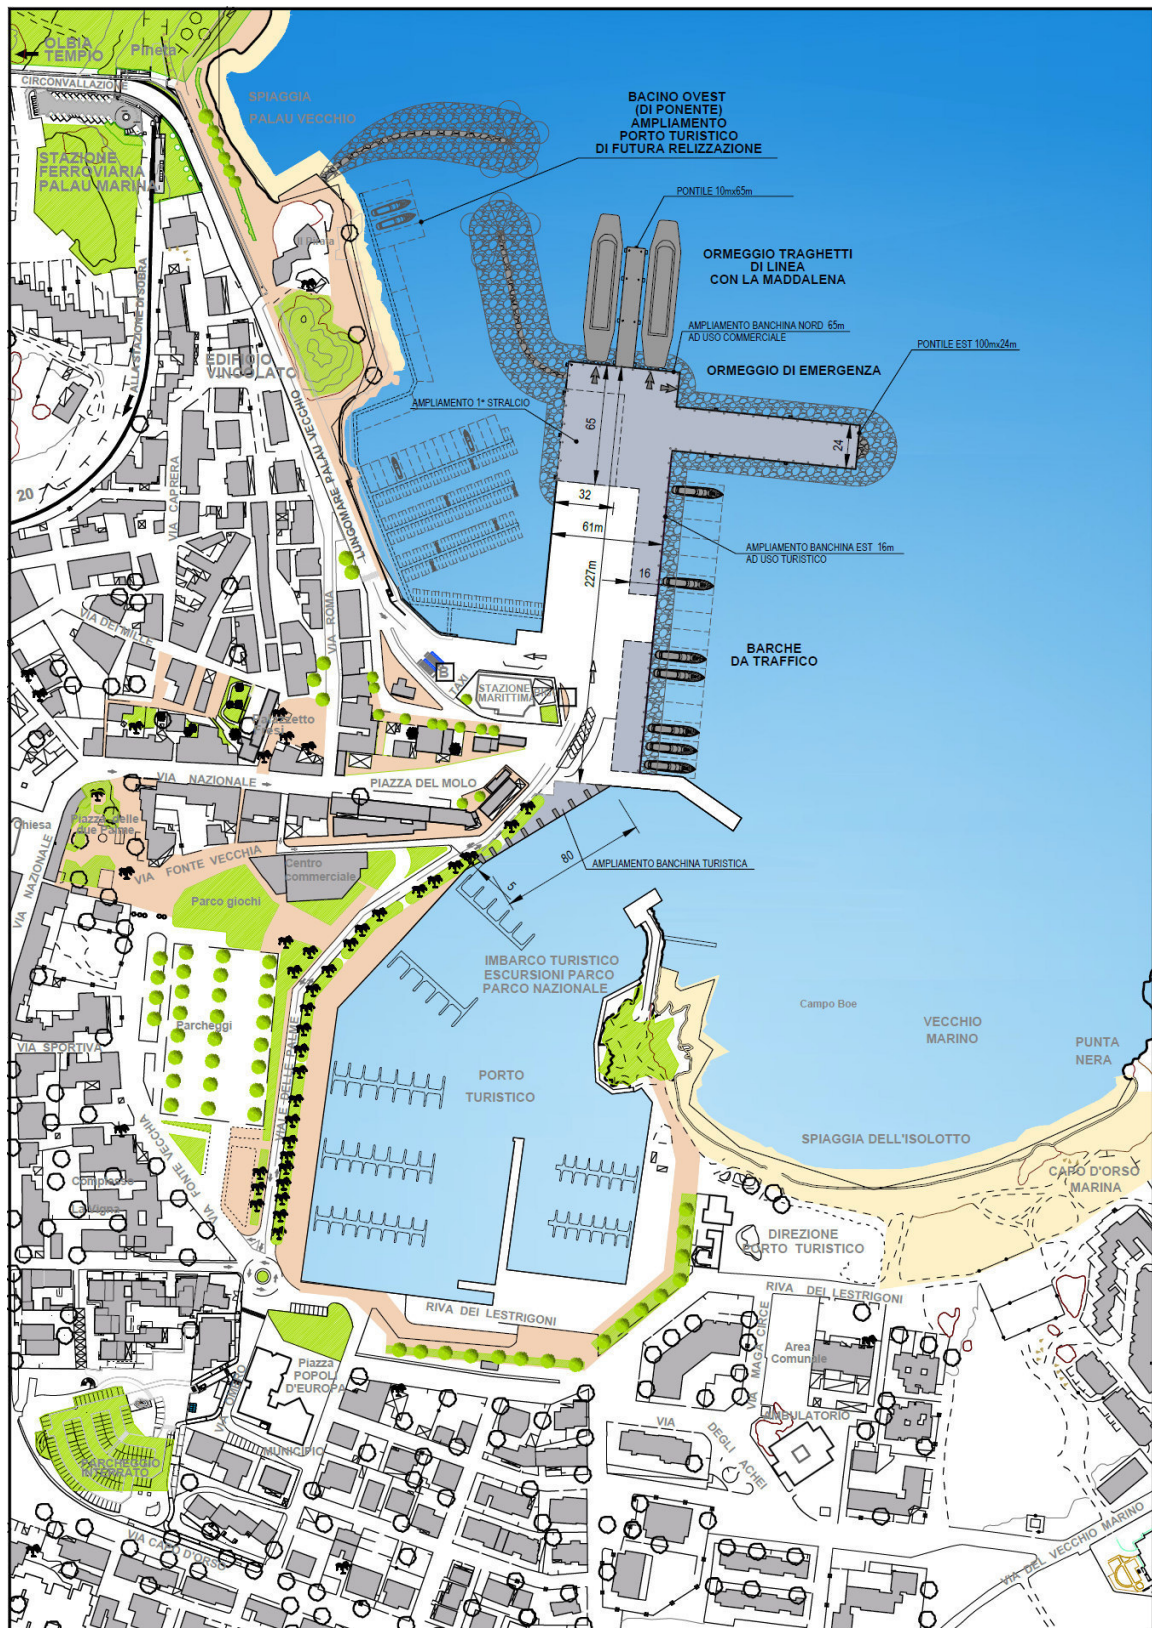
Ipotesi di "Assetto finale": Planimetria generale
